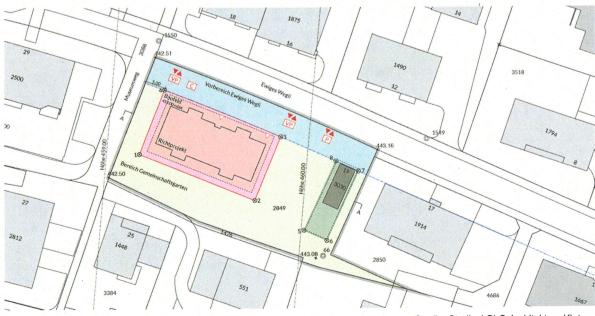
Situationsplan Privater Gestaltungsplan Rossweid
